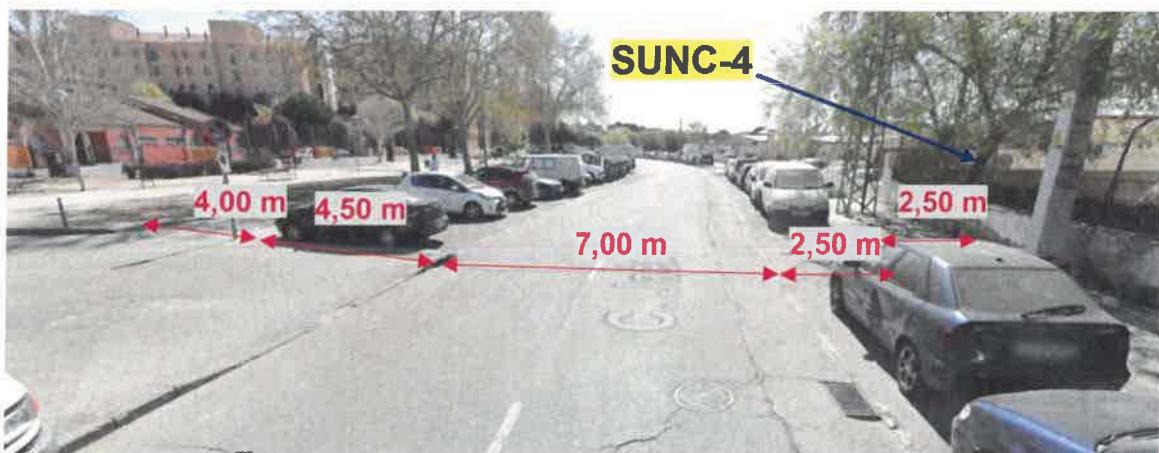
Sección de la Calle Jaén junto al SUNC-4 (situado a la derecha).
